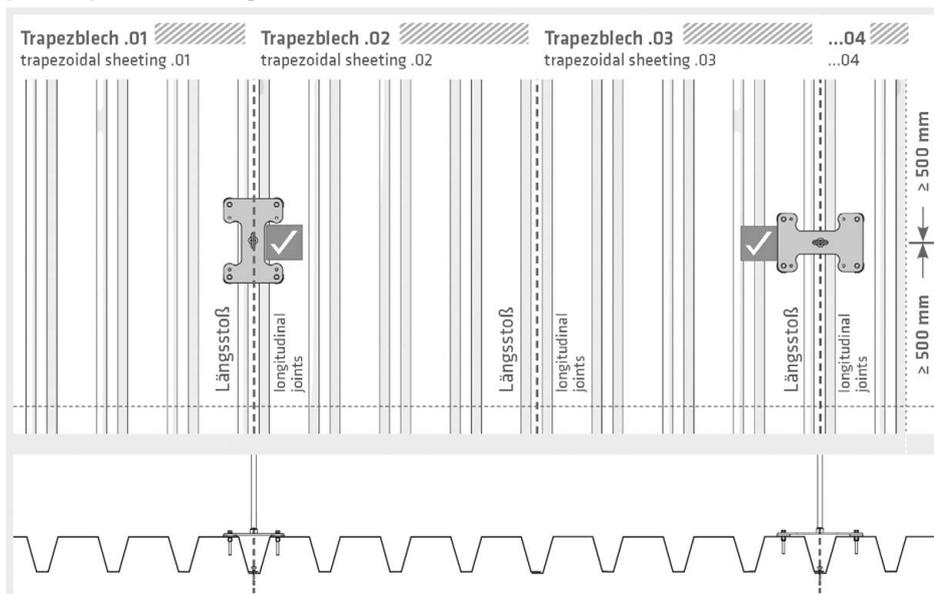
Montagevorgaben auf Trapezprofil bei Absturzrichtung in Trapezprofilspannrichtung
